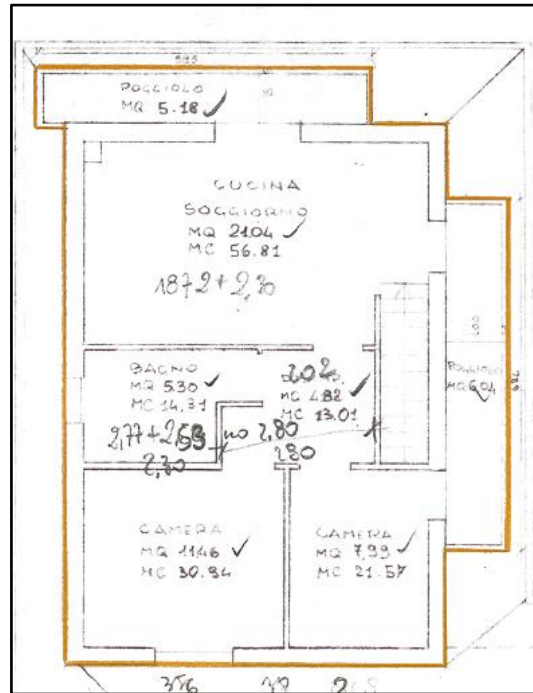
Estratto della tavola allegata alla domanda di condono edilizio rappresentante il primo piano
